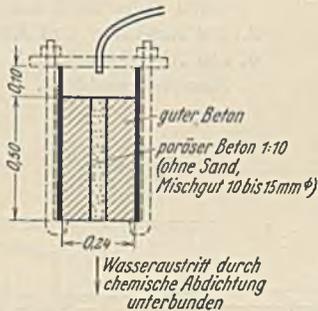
Abdichtung von porösem Beton. (Versuche Nordhausen.)
